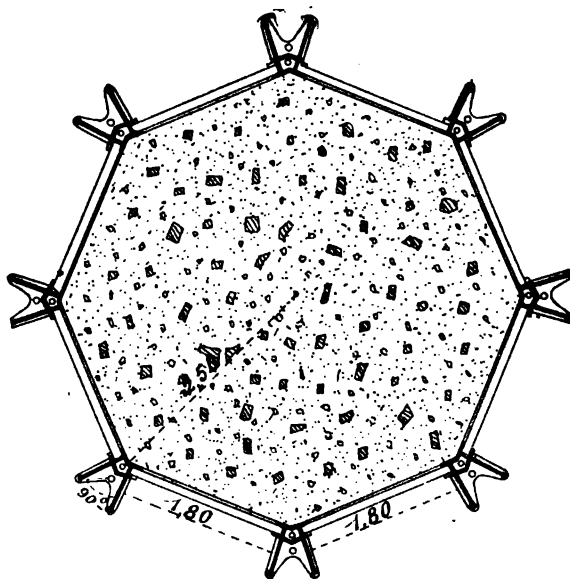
Tour-balise des Trois-Pierres. — Coffrage, plan.
